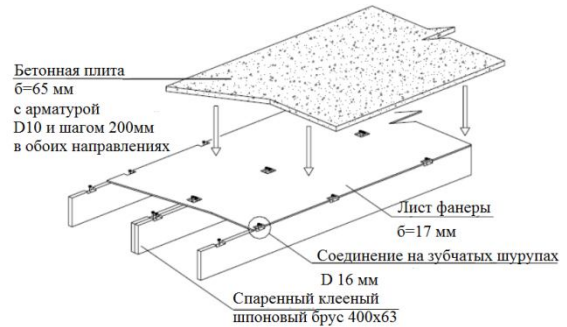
М-образная панель с железобетонной плитой / M-shaped panel with reinforced concrete slab
